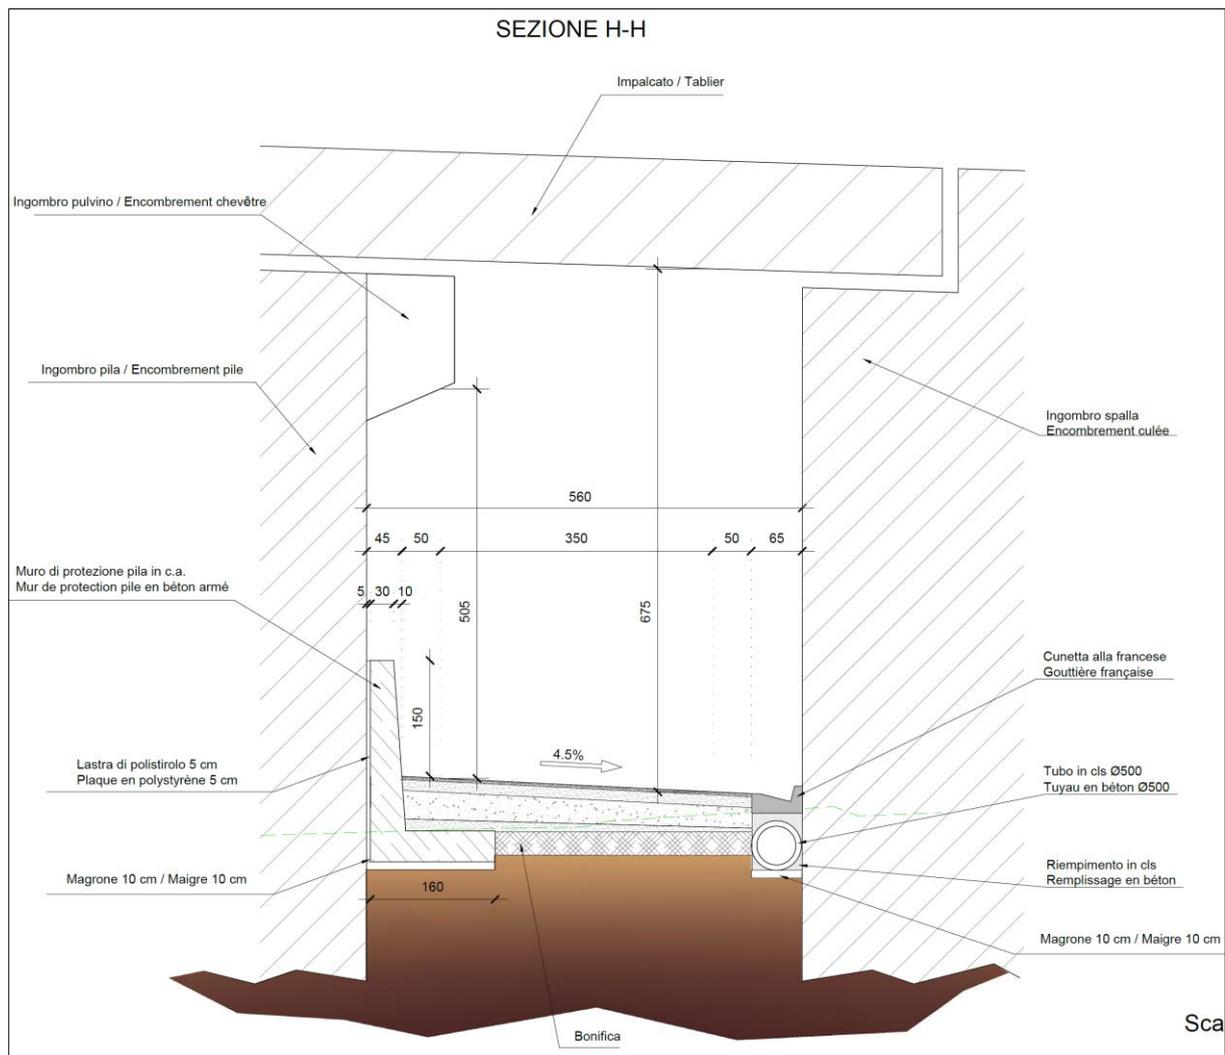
Sezione in corrispondenza del passaggio sotto il viadotto dell'A32
